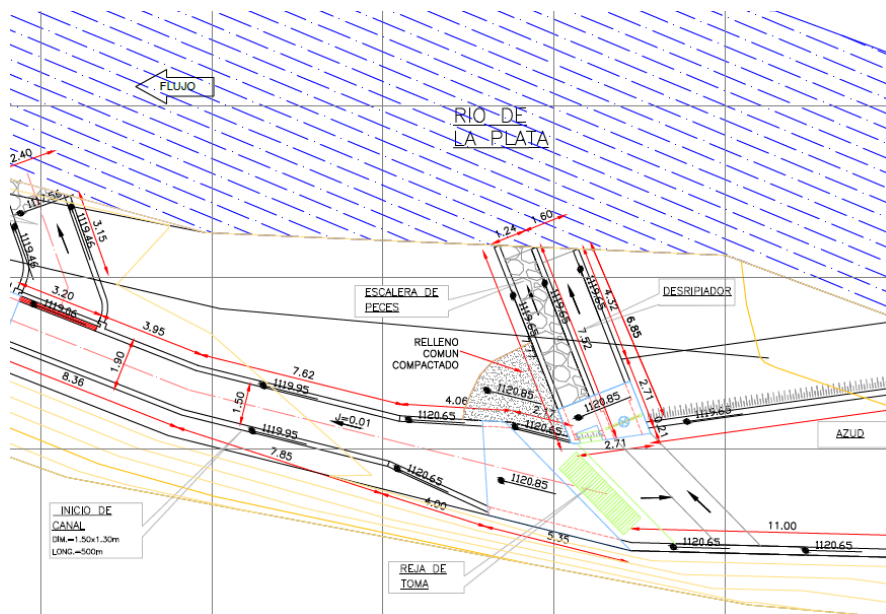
Diseño en planta de la captación del proyecto El Laurel
